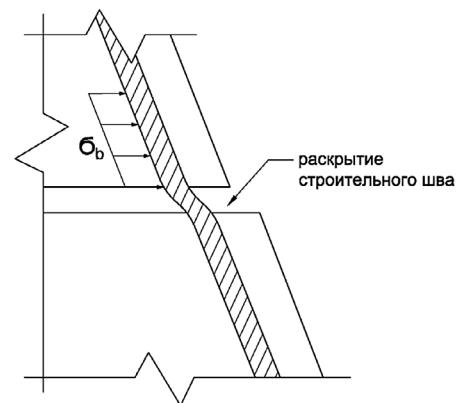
Схема работы арматурного стержня и бетона в зоне строительного шва
